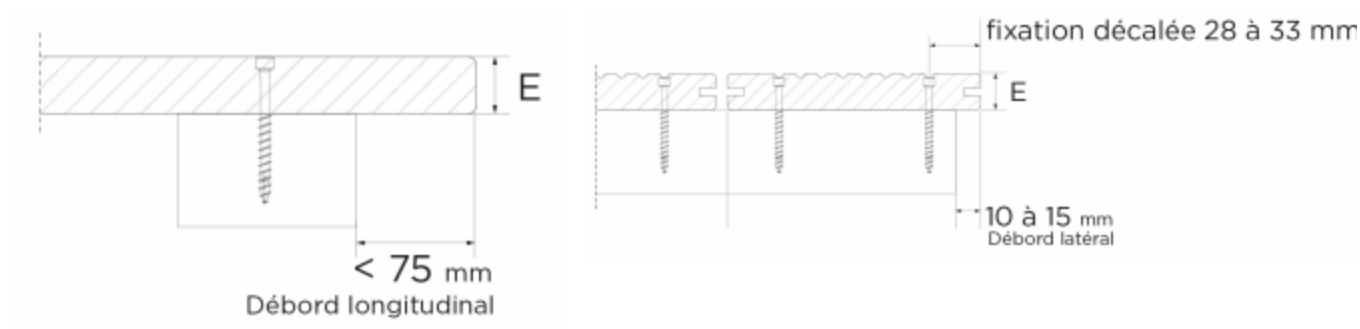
Positionnement des fixations – coupe transversale sur lames de platelage
